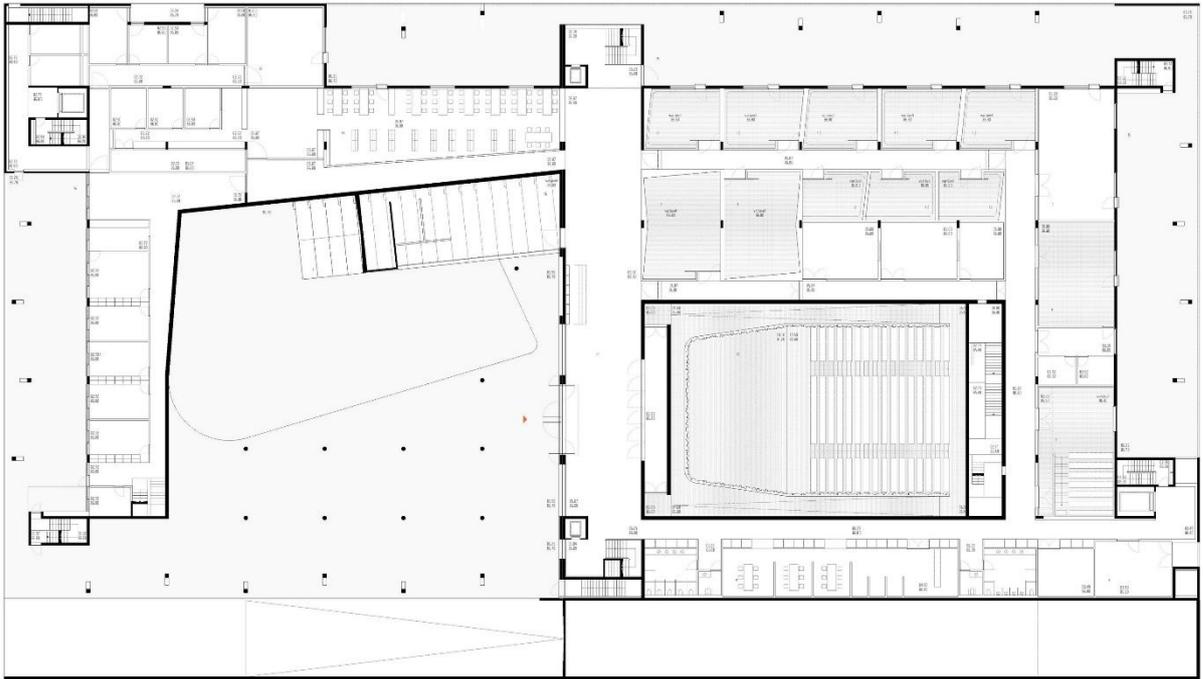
Planta do pavimento térreo (FONTE: Open Buildings, 2013).
